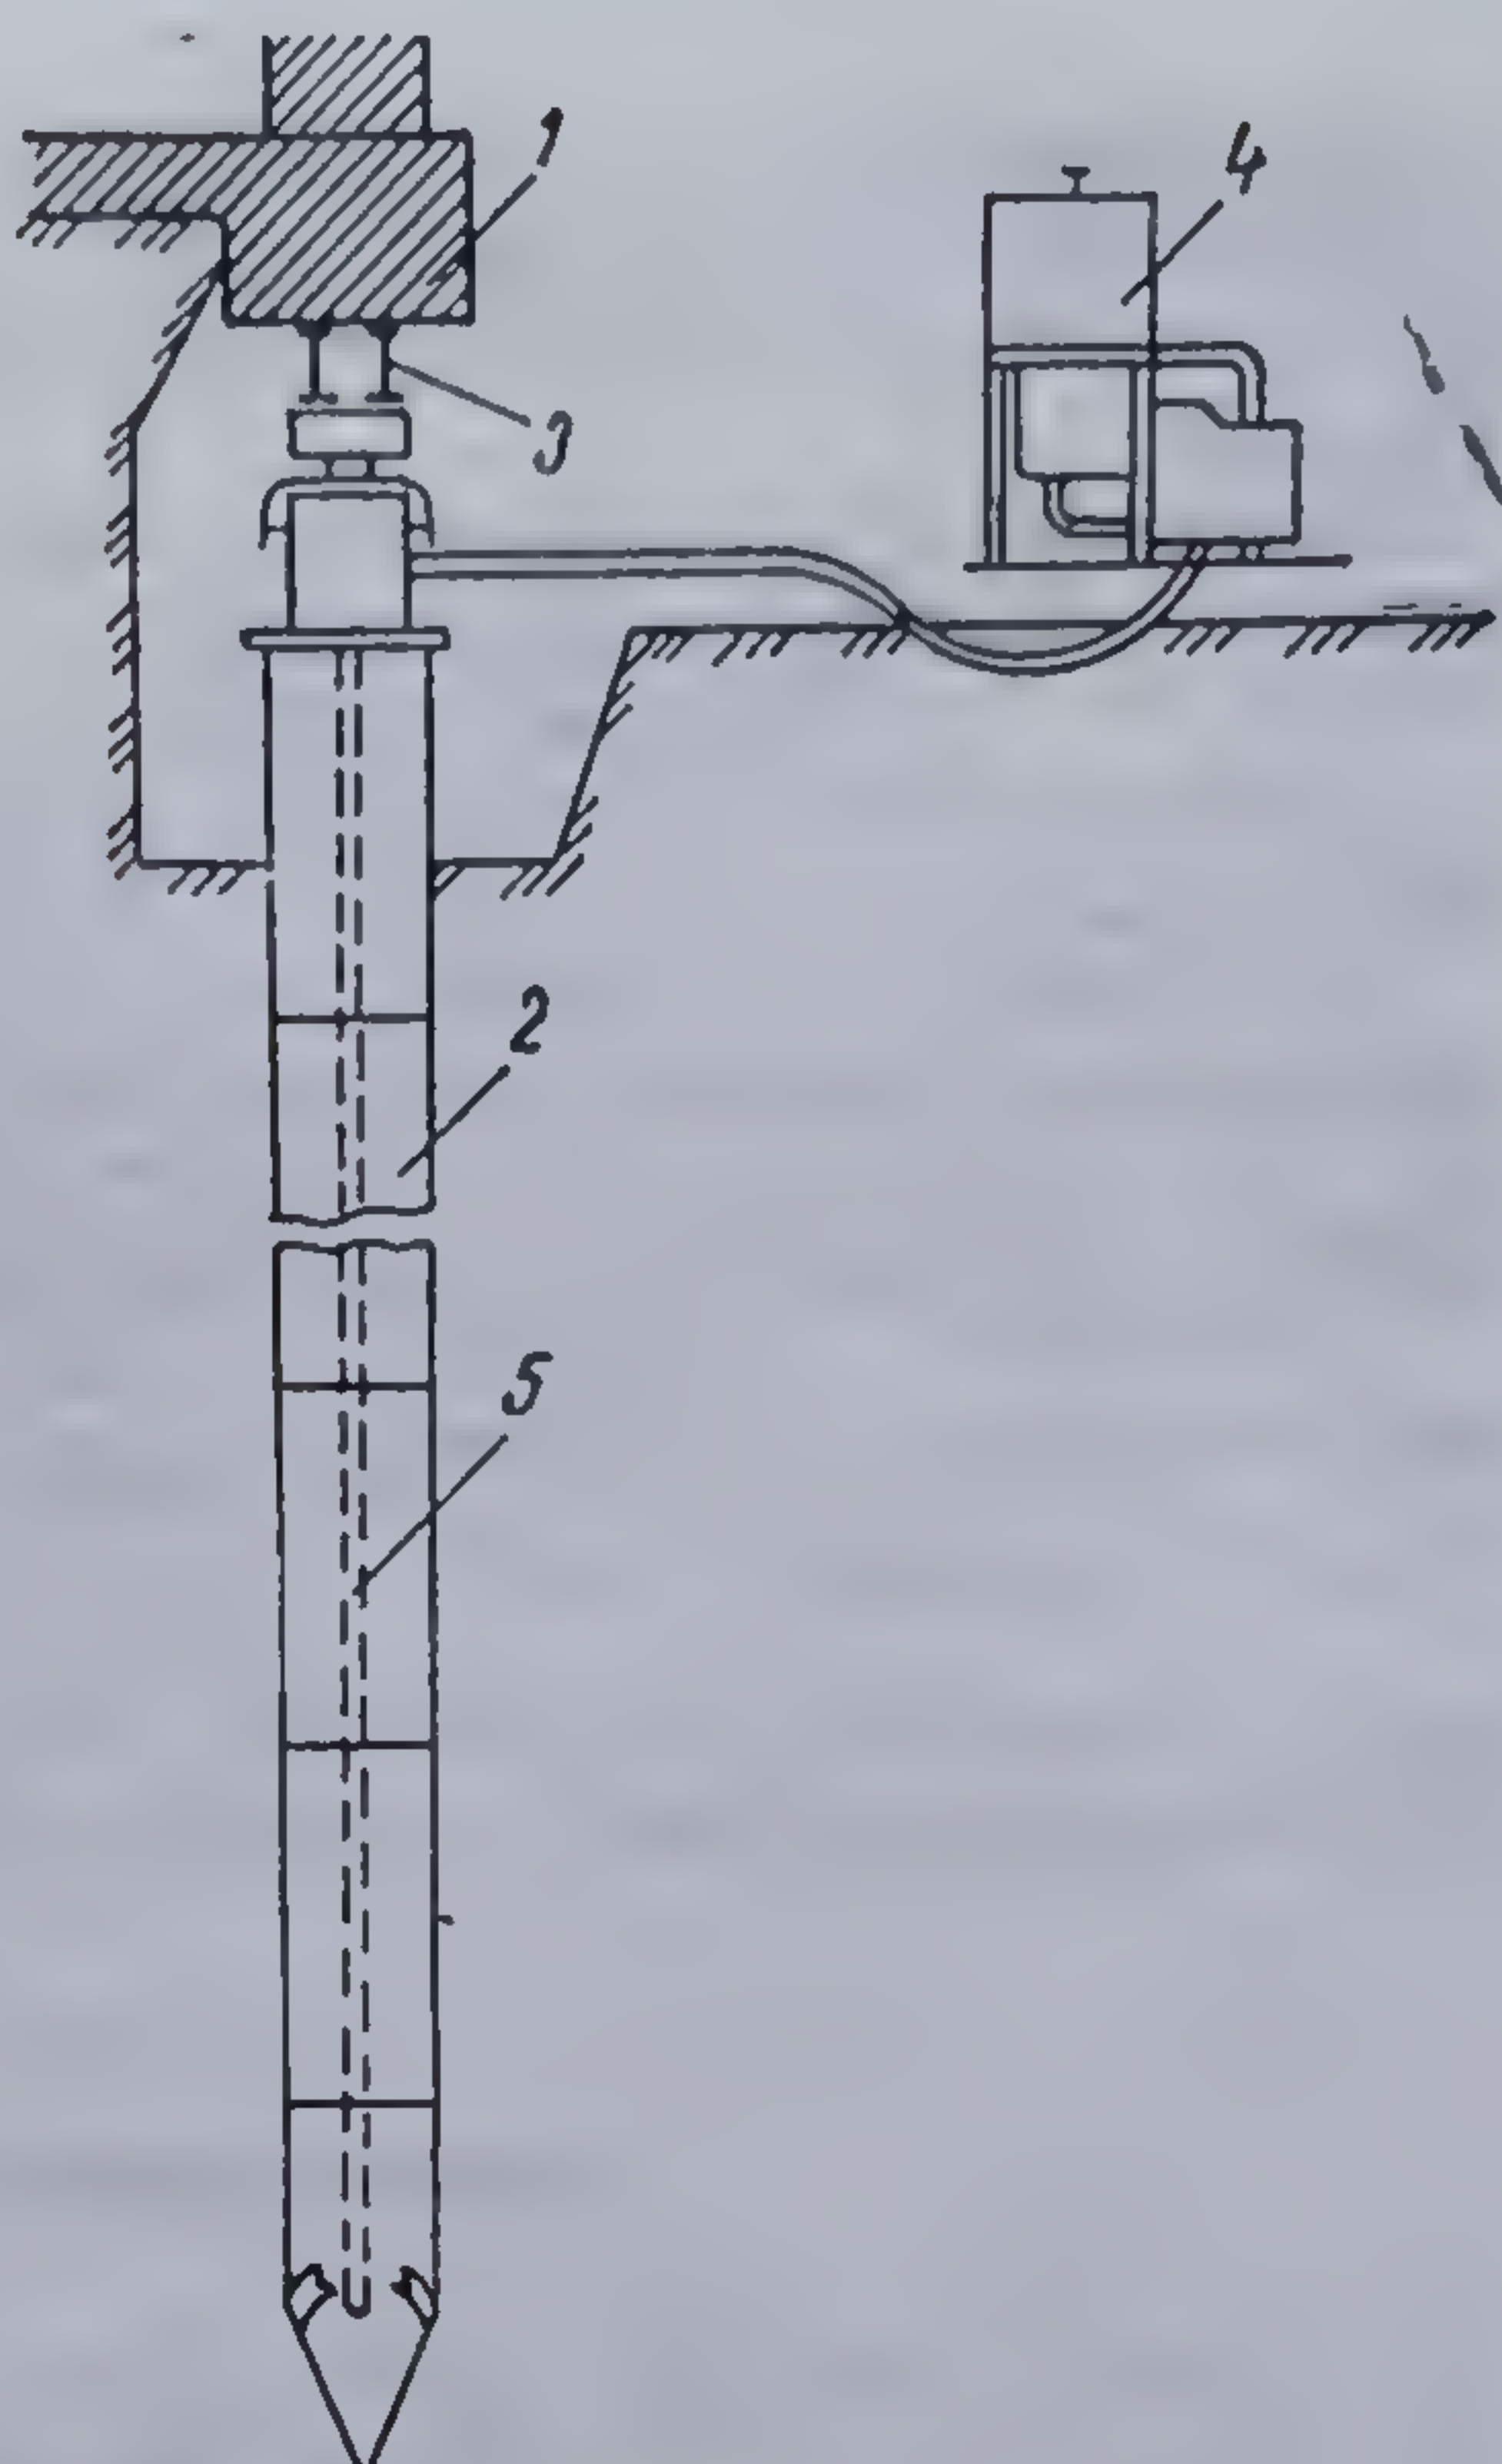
Subzidire cu piloți forăți sau cu piloți Franki-Méga :
